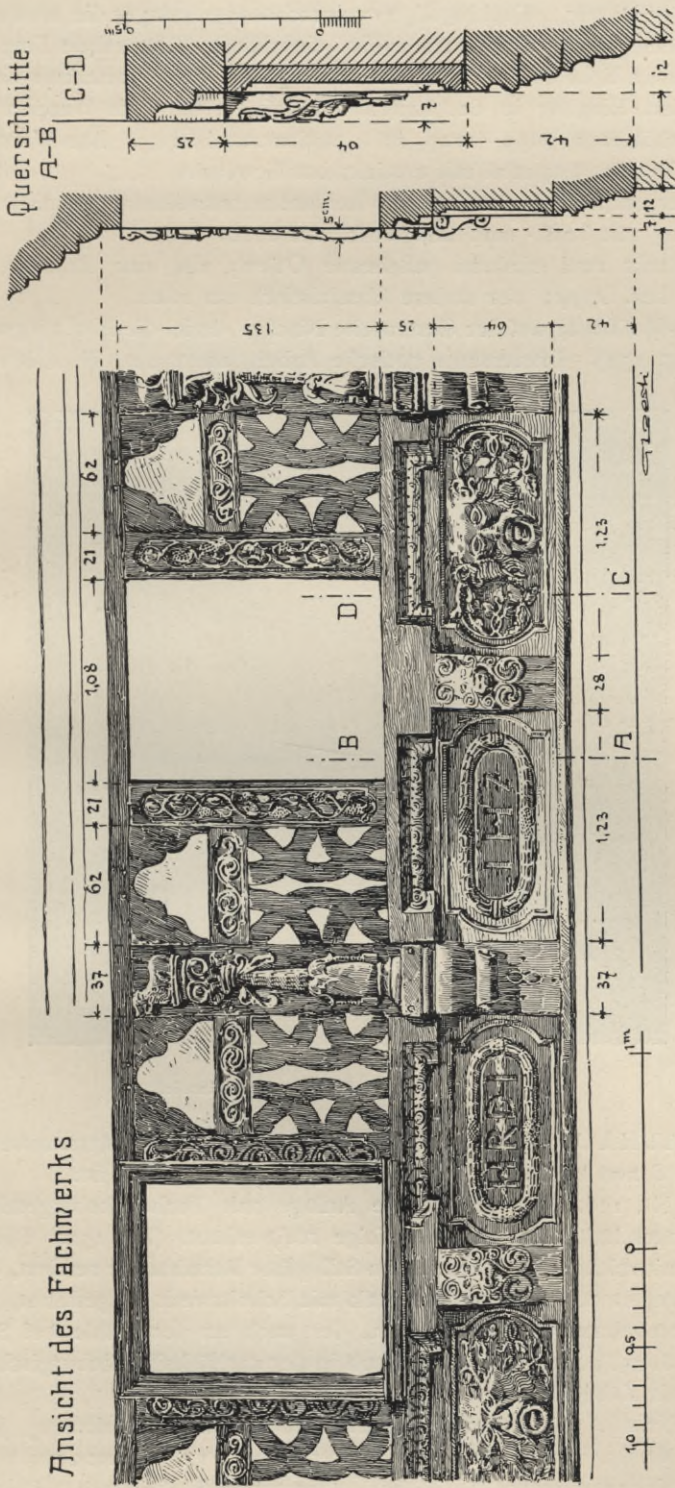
Zeil. Detail des Fachwerkhauses Nr. 126.
